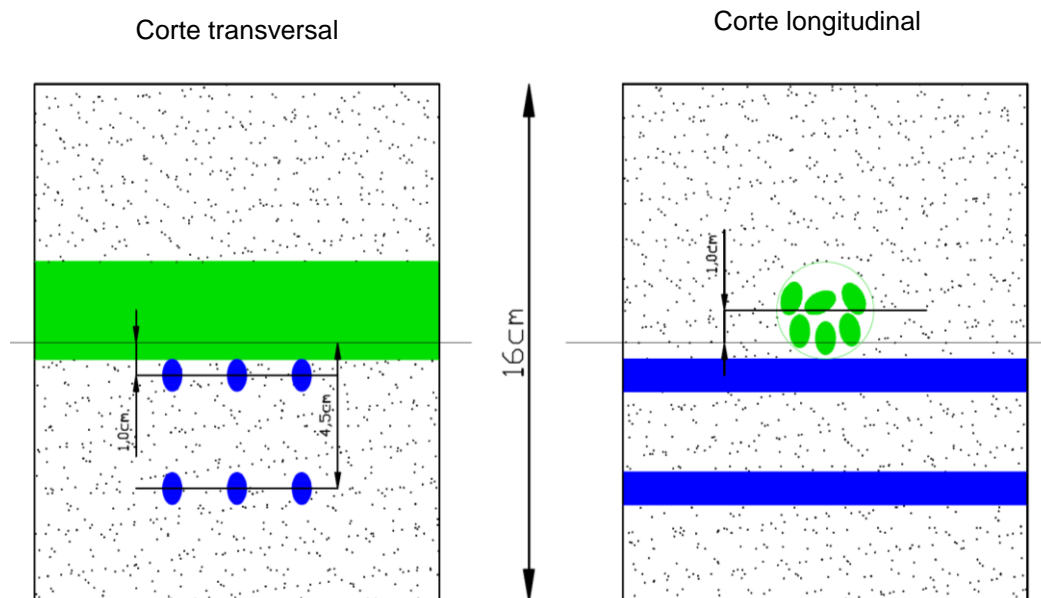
Representação esquemática da estrutura da laje de betão pré-esforçado das pistas principal e secundária da BA11.
